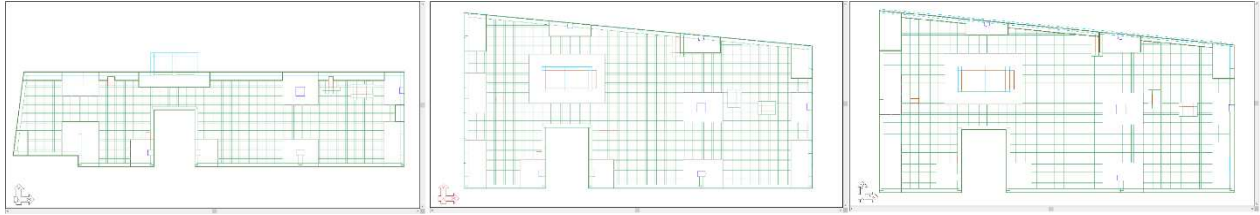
Elementos de la losa en Adapt Builder - Fuente: Elaboración propia
